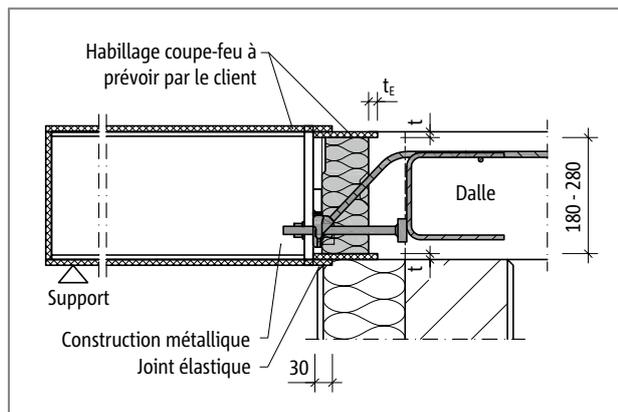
Schöck Isokorb® T type SQ : Bardage de protection incendie sur site - T type SQ et construction en acier ; coupe
